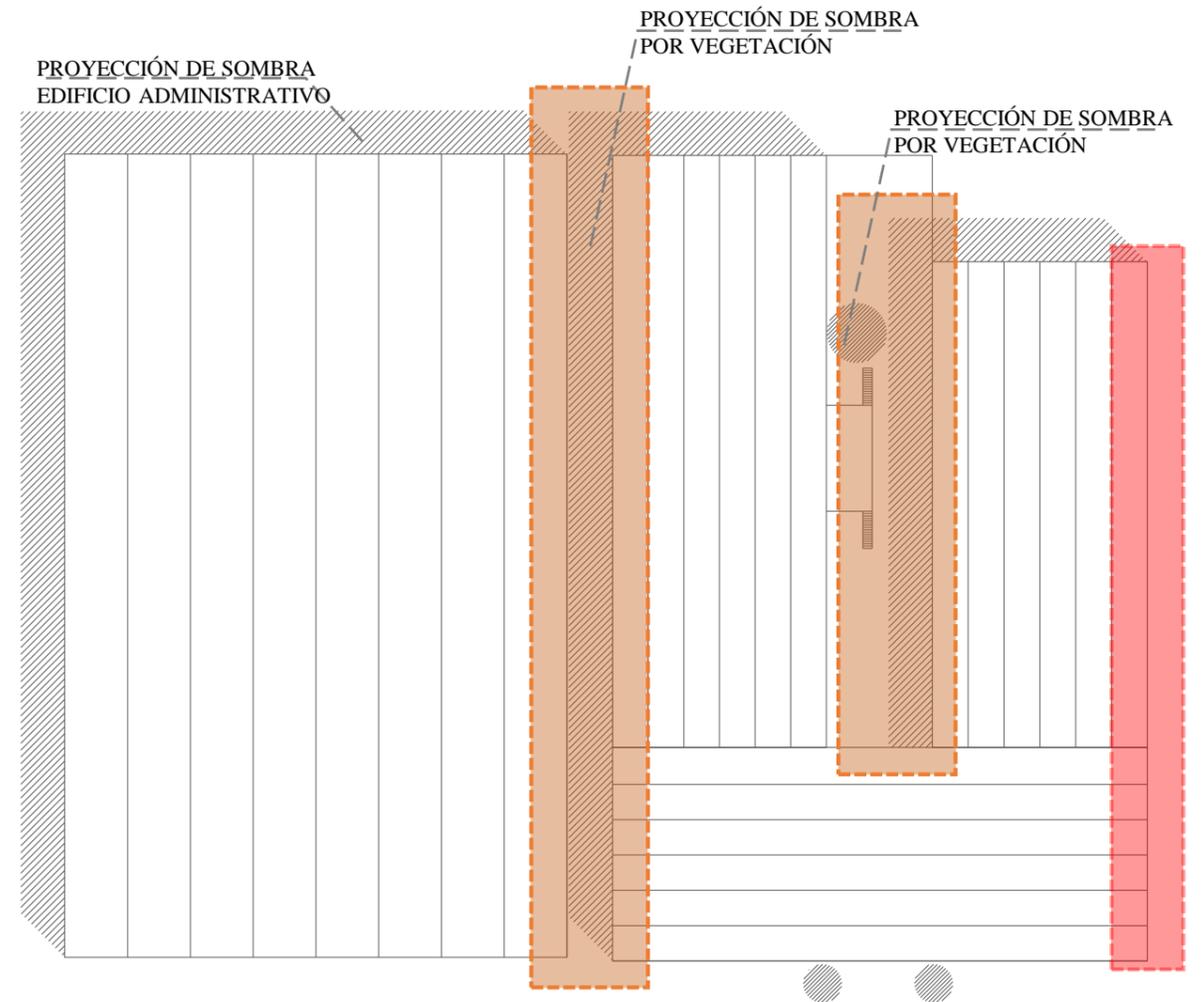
Plano de asoleamiento (Estado actual del edificio). Fuente: Ambrosi(2014)
